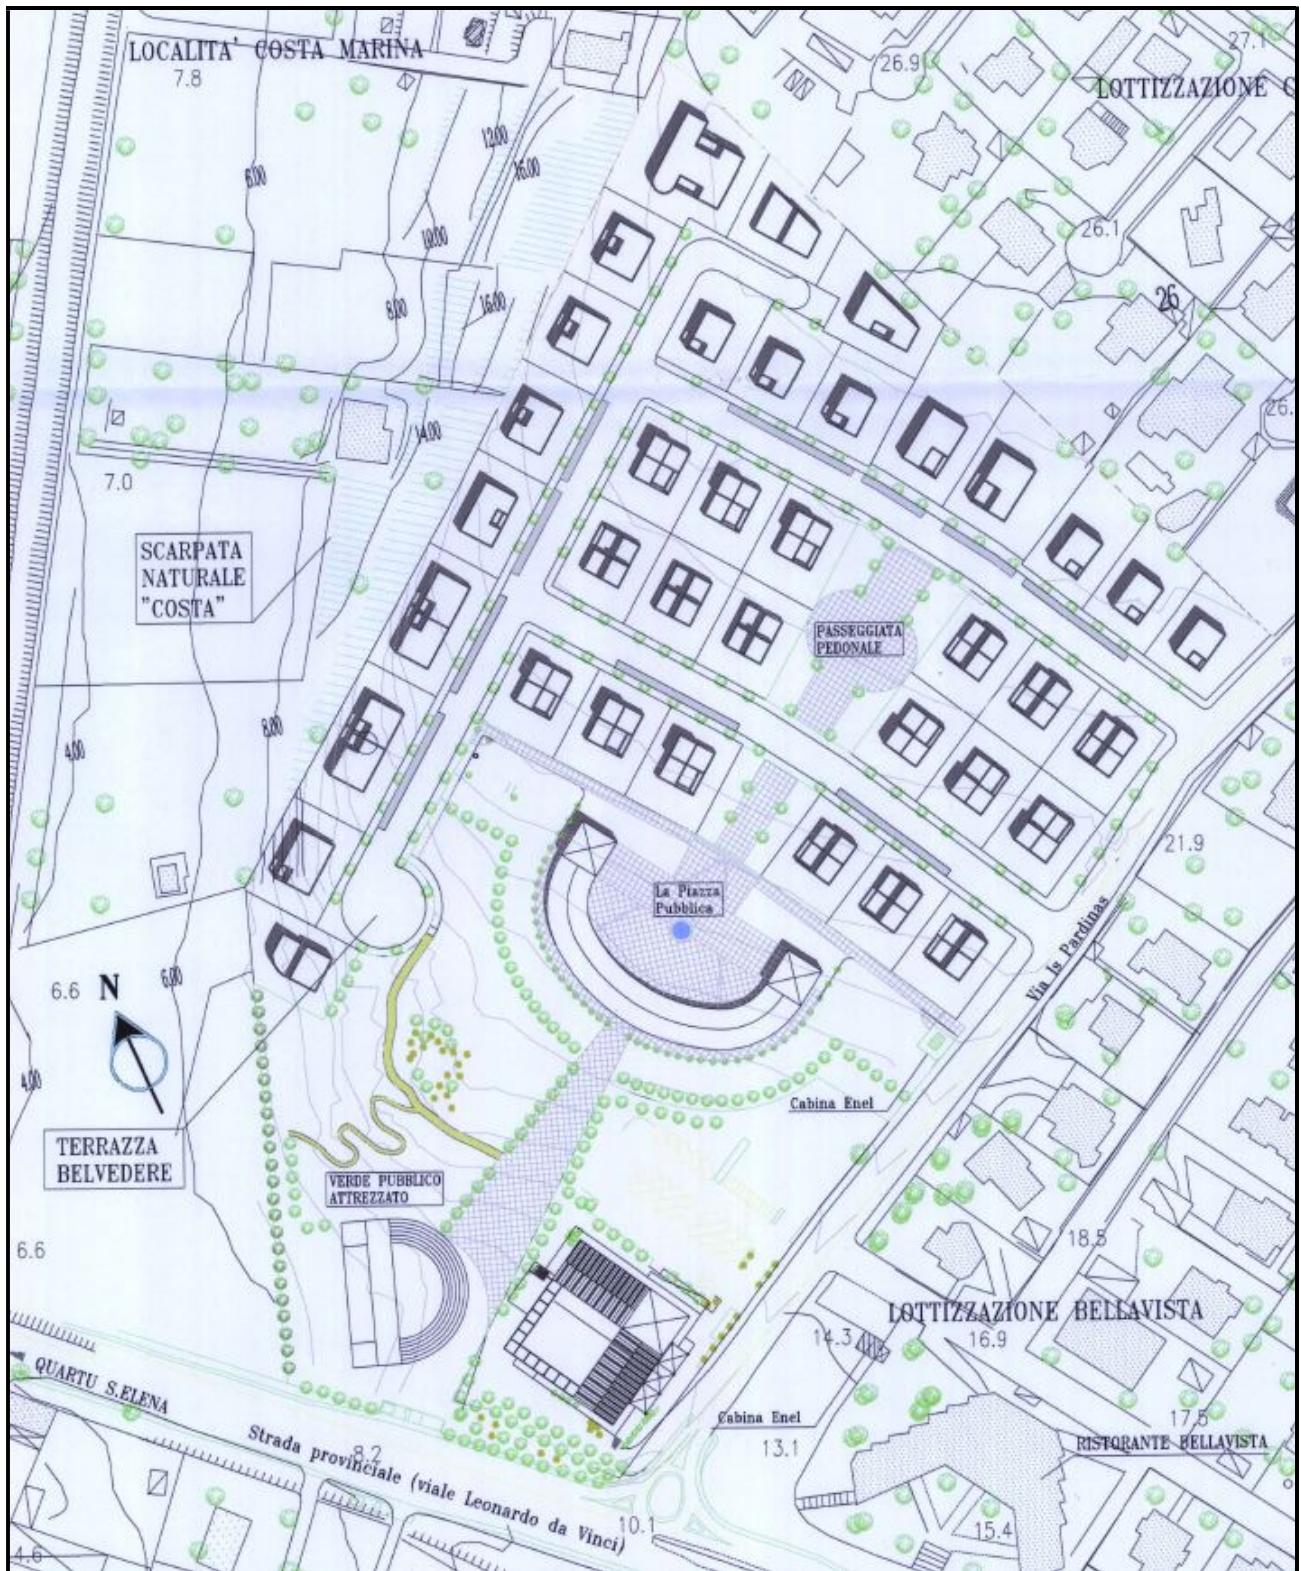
Stralcio planivolumetrico del Piano di lottizzazione (Tav. 8 – Planivolumetrico)
